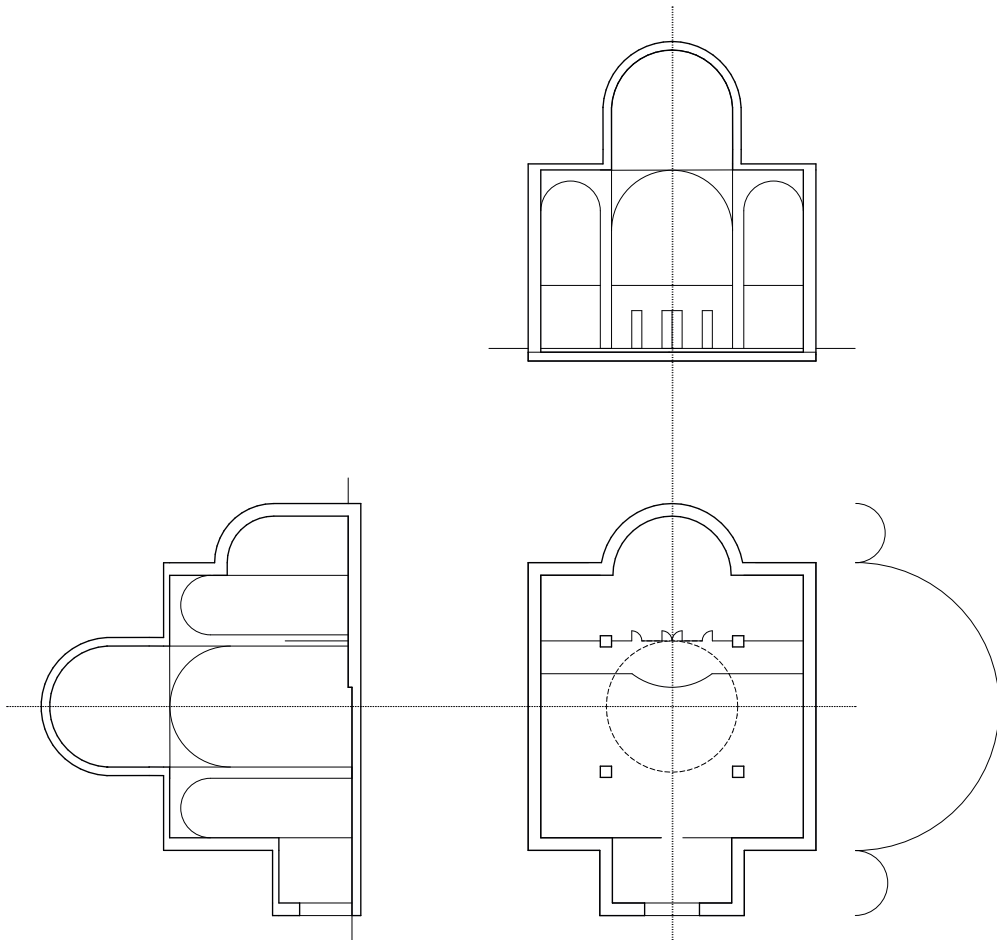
Schematischer Grundriss und Schnitte: Typologie und Aufbau einer Kreuzkuppelkirche
